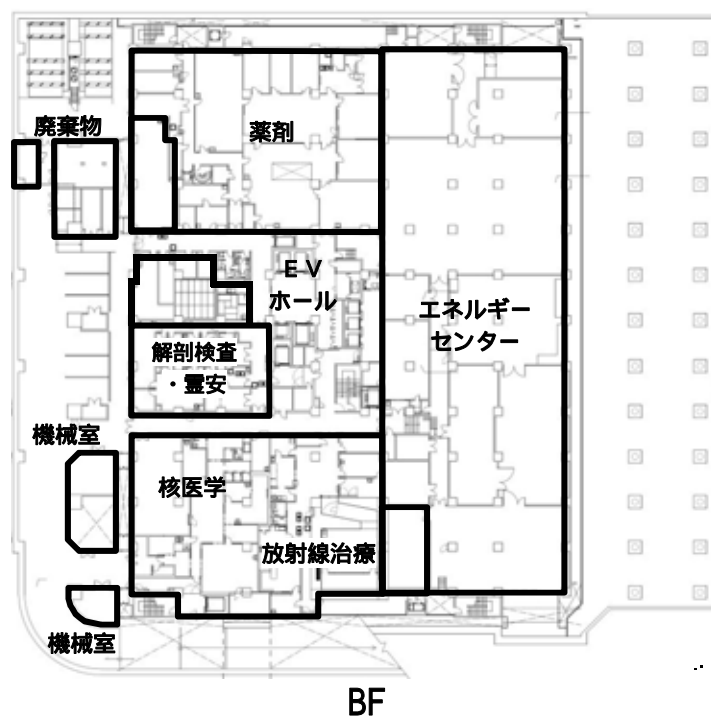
(1) 病院本館建築平面図(地下1階)(完成時)
